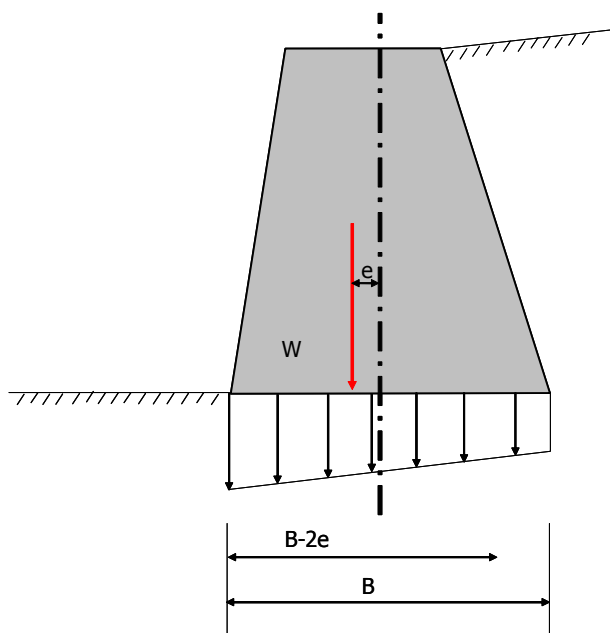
Larghezza di base equivalente per una fondazione superficiale, nel caso in cui il carico trasmesso al terreno (W) sia eccentrico rispetto alla dimensione B -
